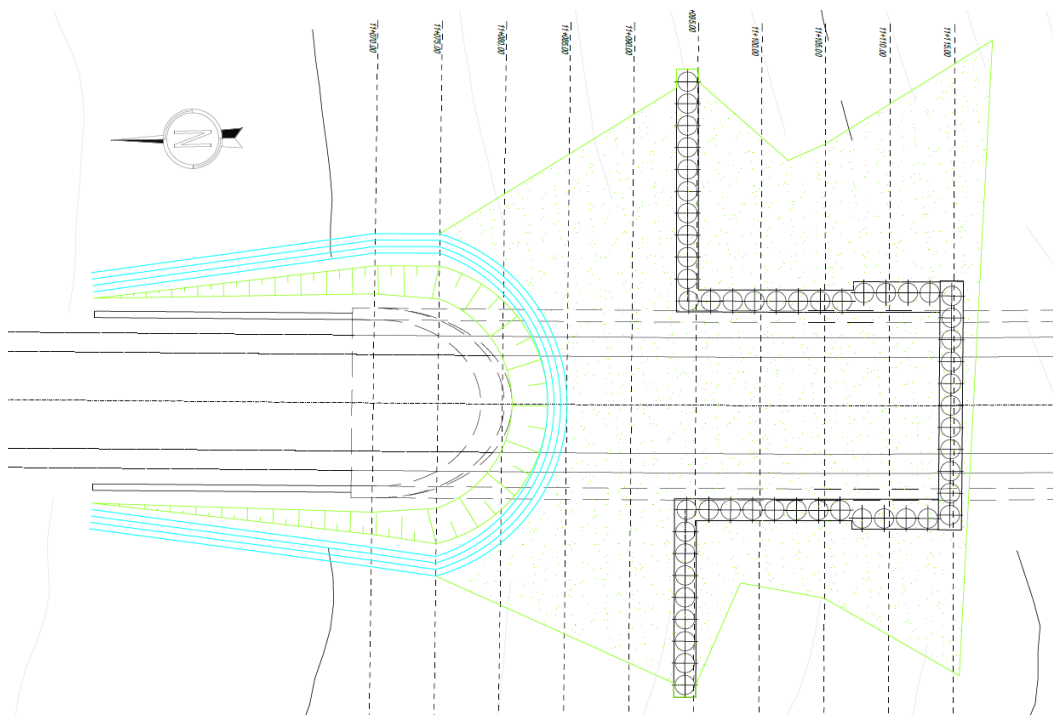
Stralcio planimetrico imbocco A (Lato Nord)
